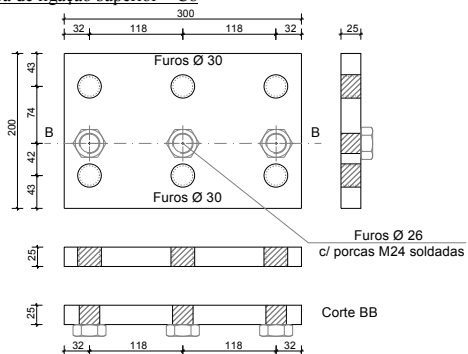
Geometria dos elementos metálicos usados na ligação superior (dimensões em mm)
